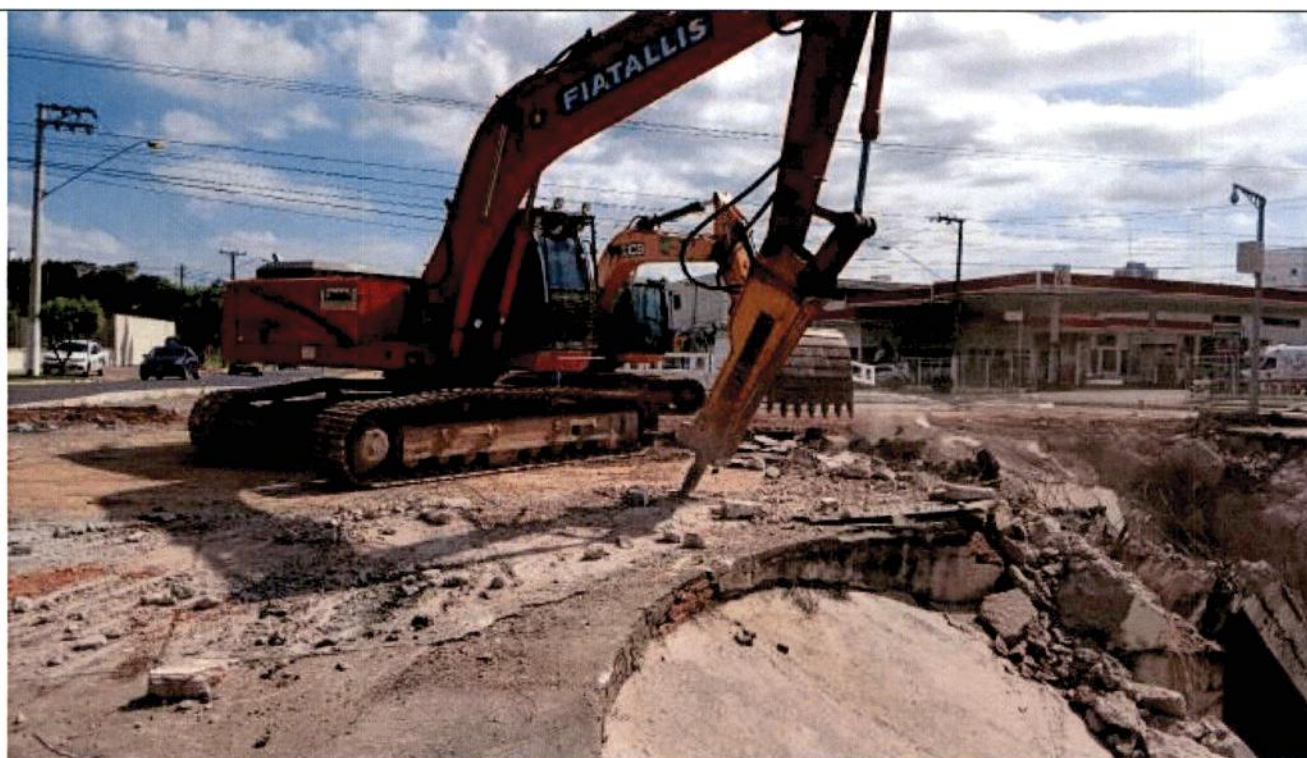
Demolição dos dispositivos de concreto armado – Rua Barão de Melgaço com Av. Oito de Abril;
